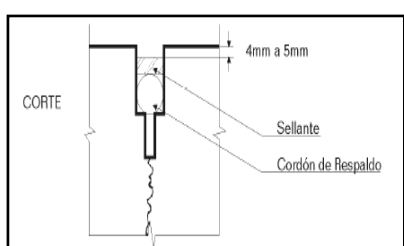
Corte- Fuente (Deterioros en pavimentos flexibles y rígidos)- Ricardo Javier Miranda Rebolledo
